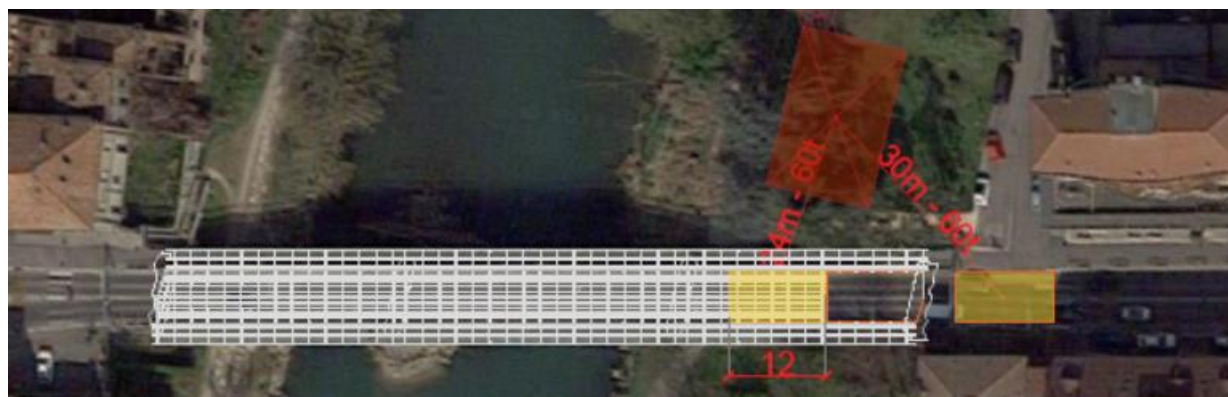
Taglio e rimozione seconda porzione di impalcato
